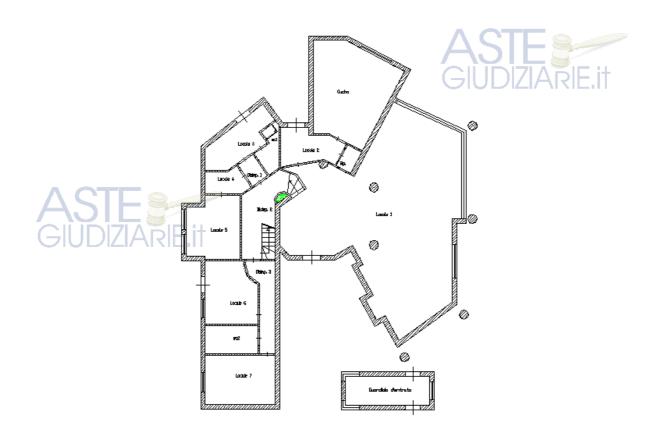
Planimetria della villa: Piano Terra: Fgl 110 p.lla 470 graf. alle p.lle 471, 473 e 493 sub 1
